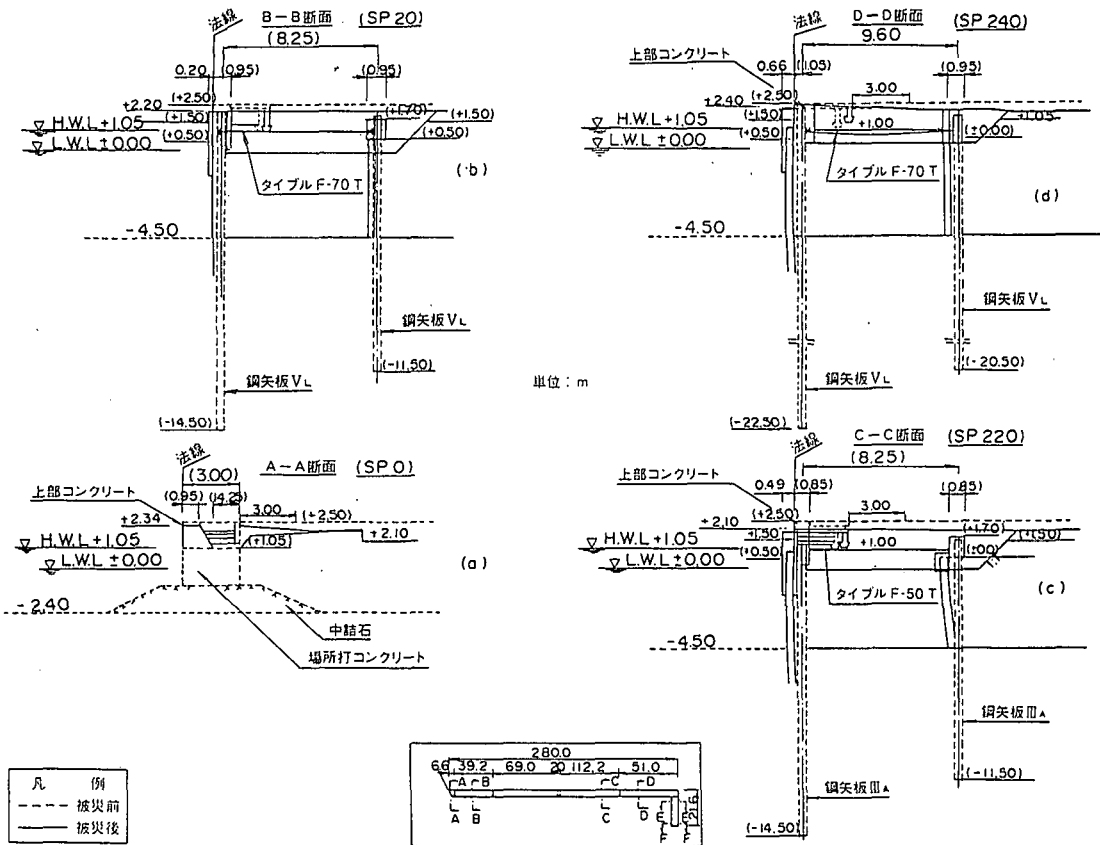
函館港若松地区道路護岸 (-4.5m) 被災断面図
